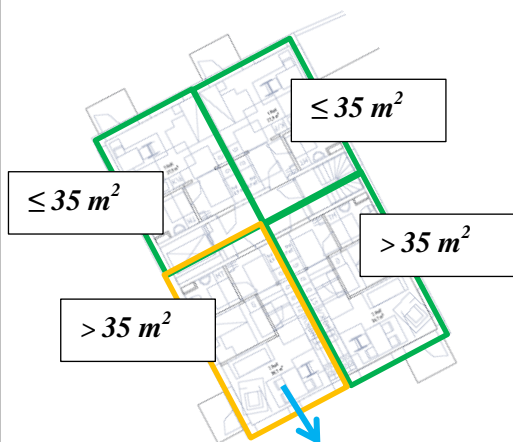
Översikt av föreslagen planlösning för ett typplan med mindre lägenheter.
